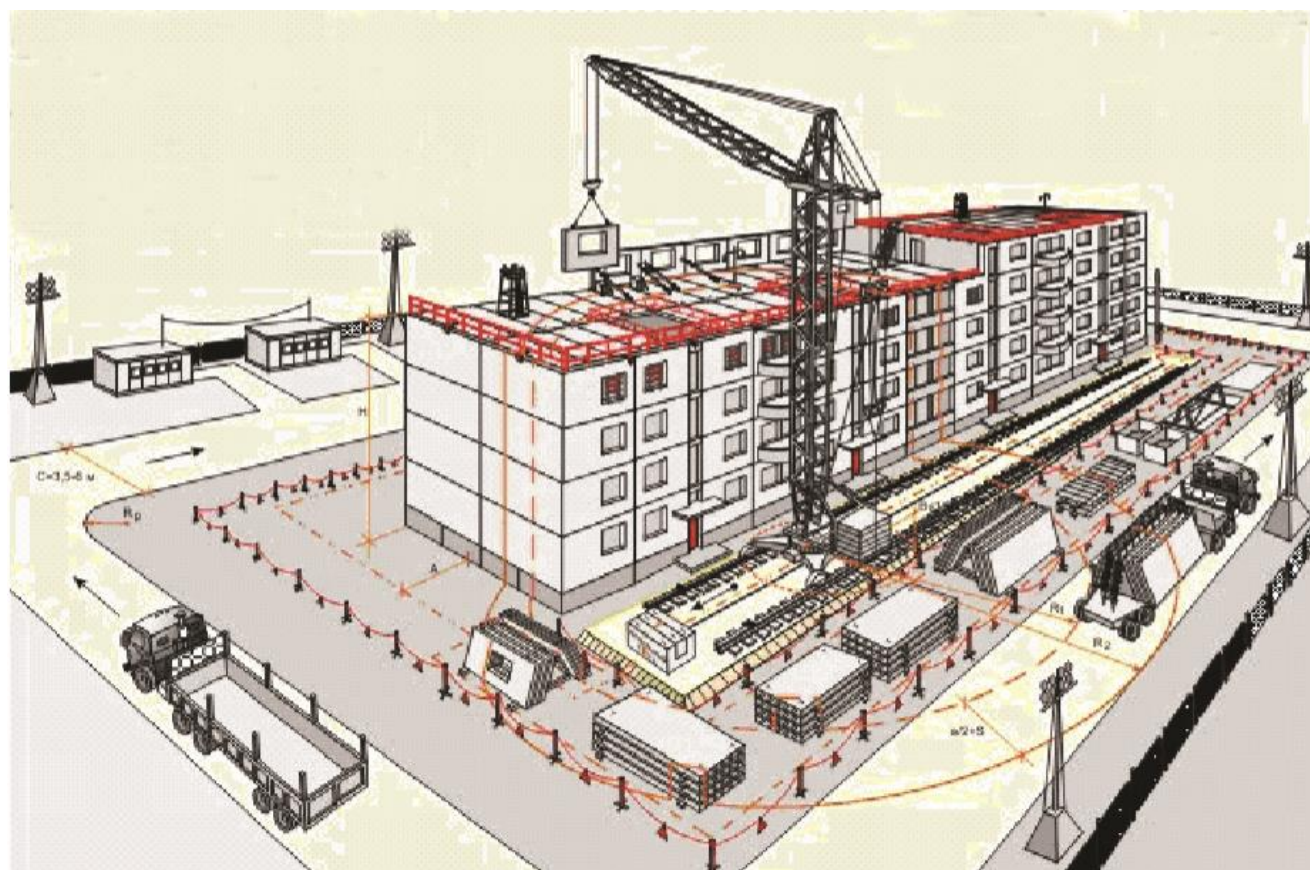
Типовые решения стройгенплана на возведение здания из штучных материалов.
